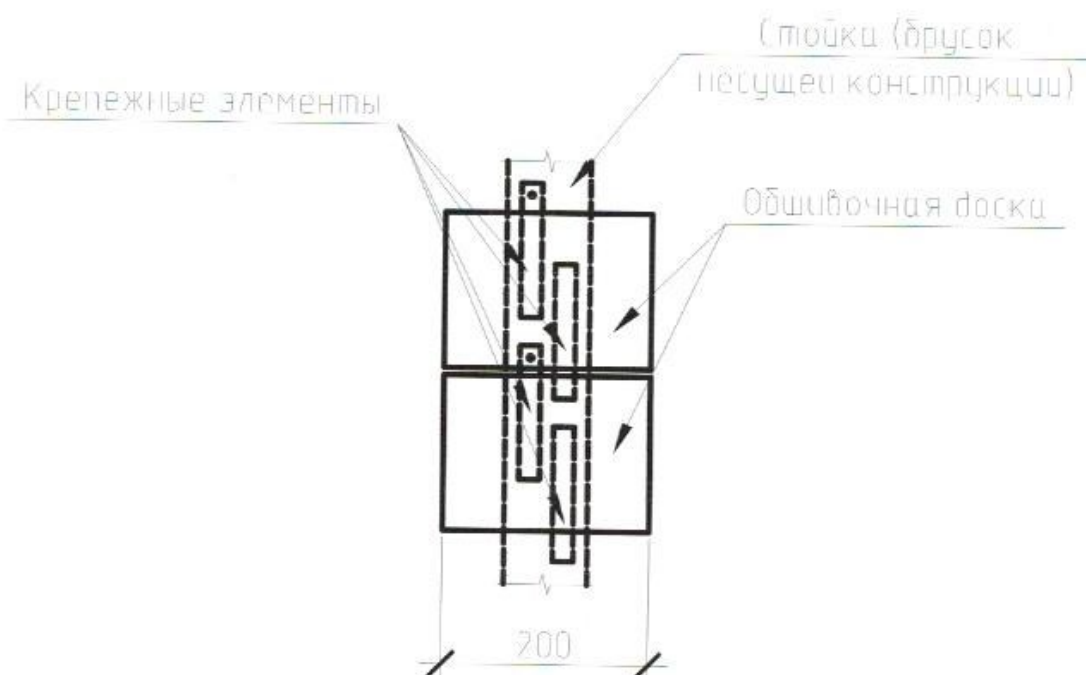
Образец для испытаний (на сдвиг и на вырыв).
